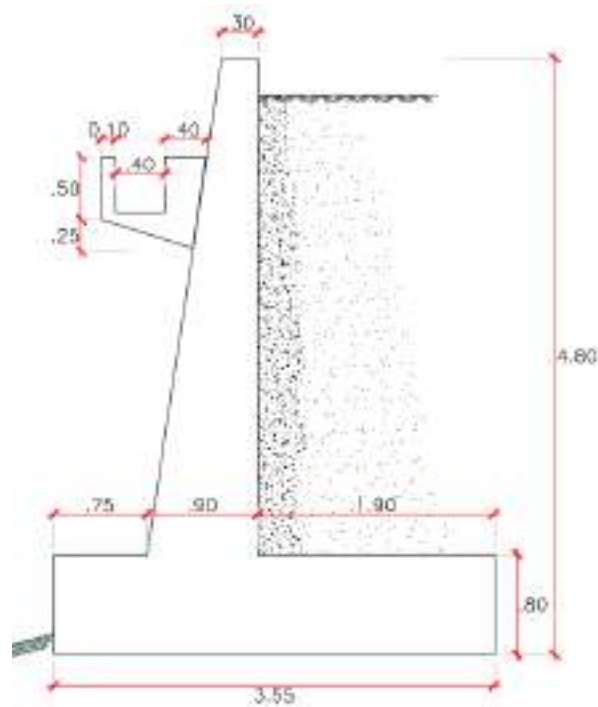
Dimensionamiento de muro en voladizo H=4.80m y canal de riego
